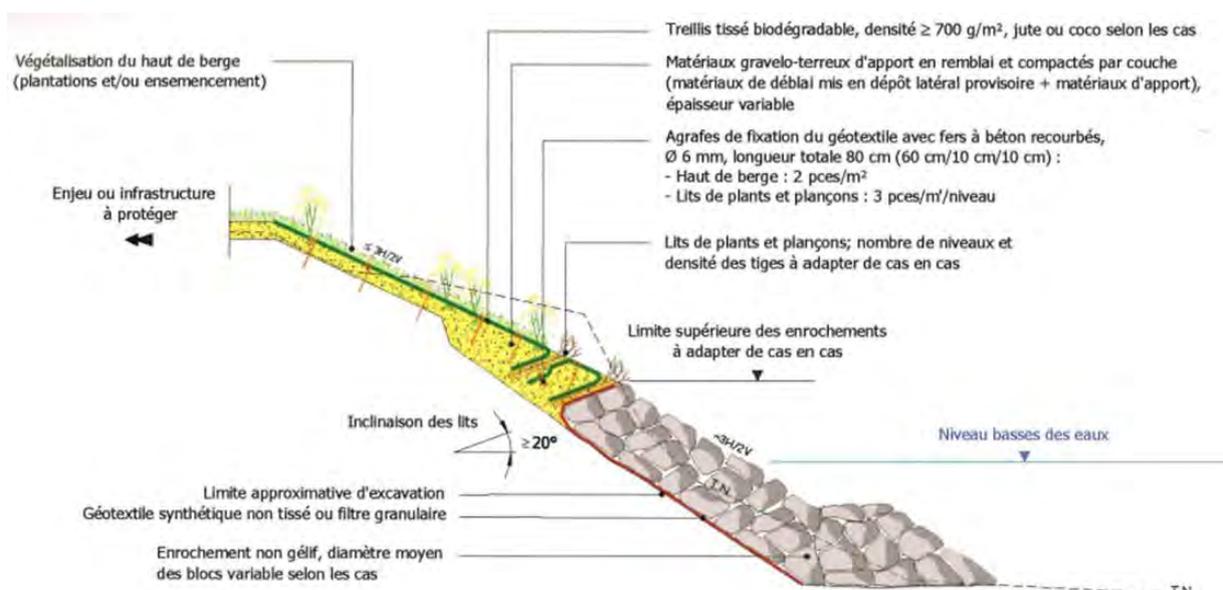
Exemple de profil type d'aménagement associant empierrement de pied et techniques végétales (en l'occurrence des lits de plants et plançons renforcés au moyen de boudins de géotextile) (Adam et al., 2008)
